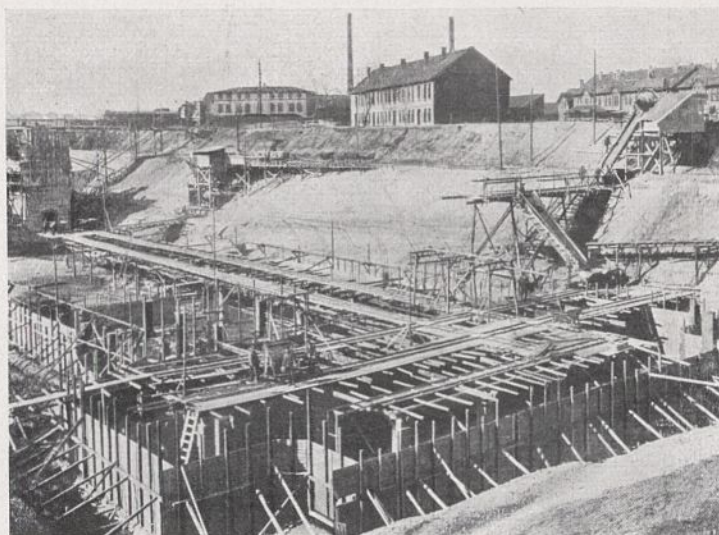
Arbeitsvorgang beim Einbringen des weichen Betons in den Sohlenabschnitt Va.
